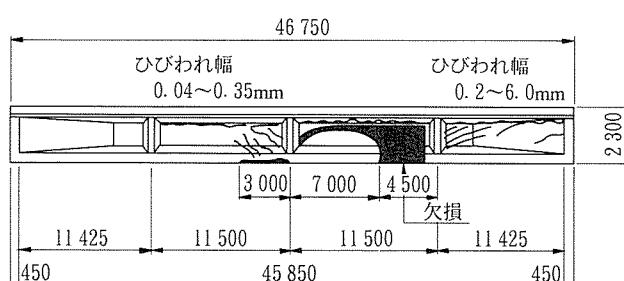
P 101～P 102 径間 耳桁 (G 1) 損傷状況
